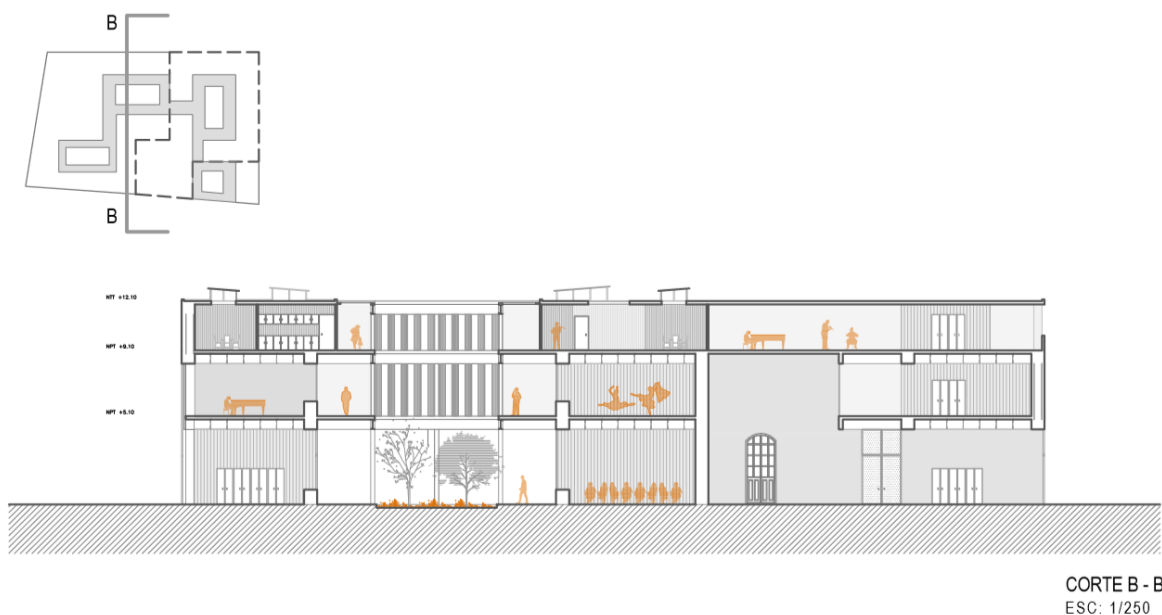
Sección transversal de la propuesta arquitectónica Politécnico Pedro A. Labarthe
